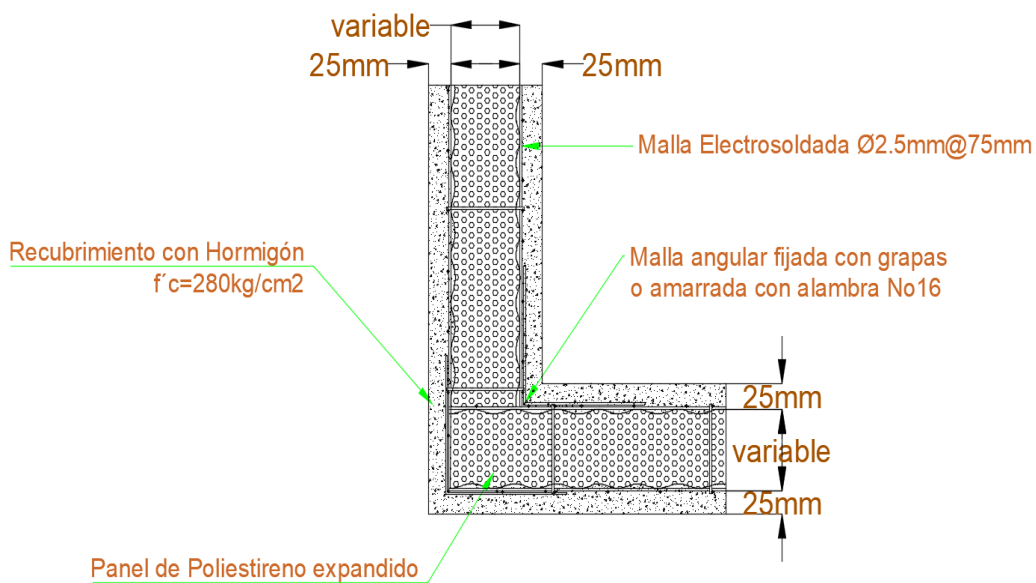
Detalle unión paneles en esquinas (PLANTA)
